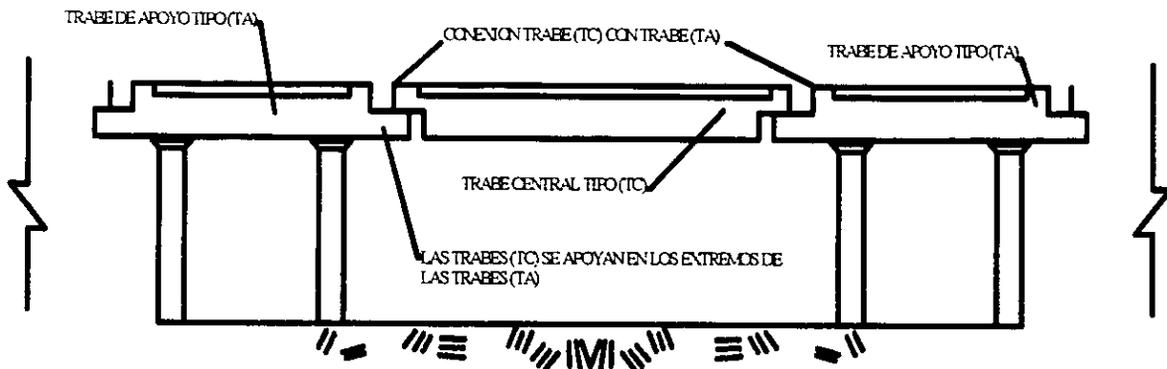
Corte longitudinal 1er. Nivel con columnas coladas en sitio de sección oblonga de 0.90x1.60 m.
